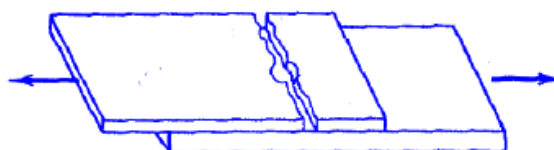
Colapso por separação transversal da chapa. [6]
